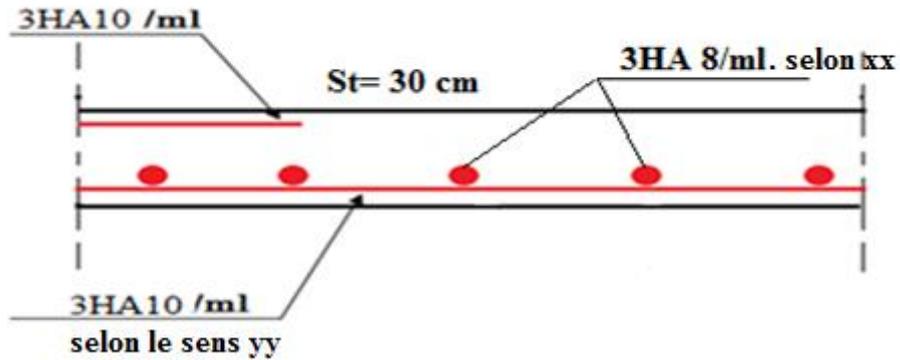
Schéma de ferrailage de la dalle sur deux appuis
